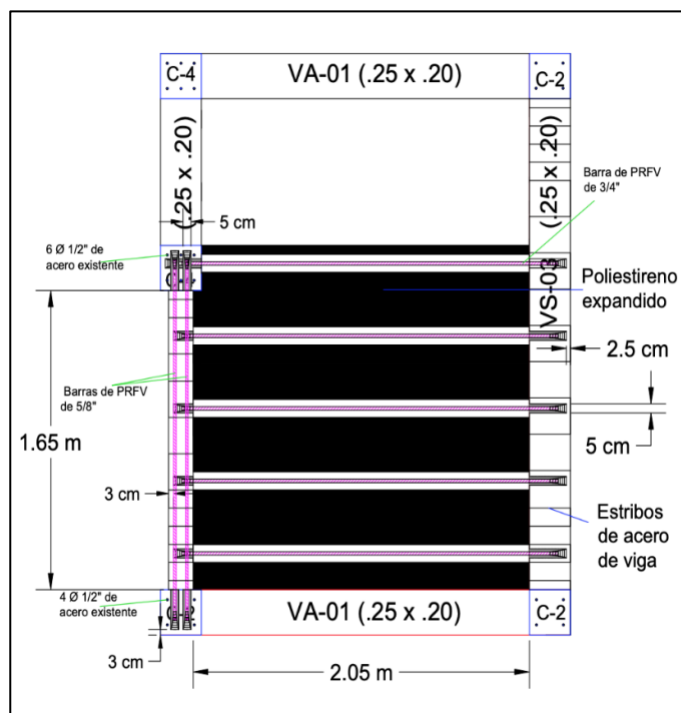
Esquema de rehabilitación de viga y losa de concreto con refuerzo de PRFV, según análisis.
